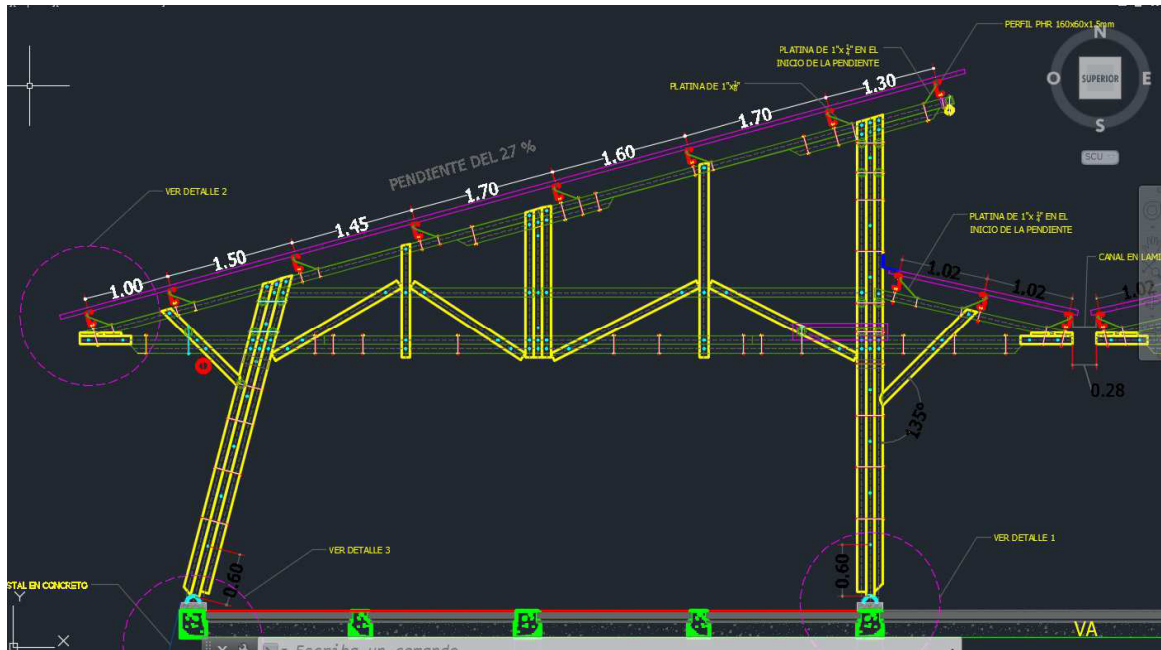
detalle de cubierta “plano estructural 6 de 9”
